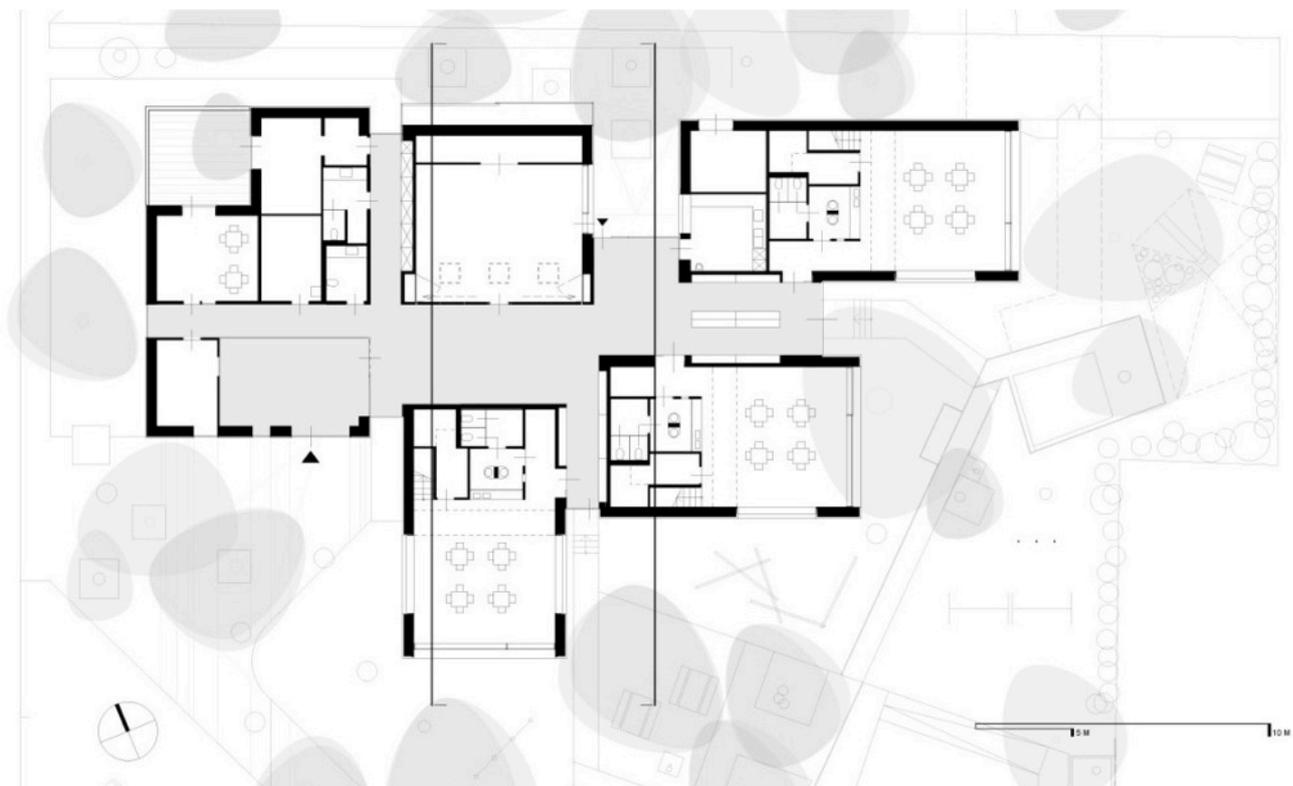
Planta 1º pavimento – a implantação das salas parece mimetizar a posição das árvores do terreno (FONTE: PLUSMOOD, 2012)
